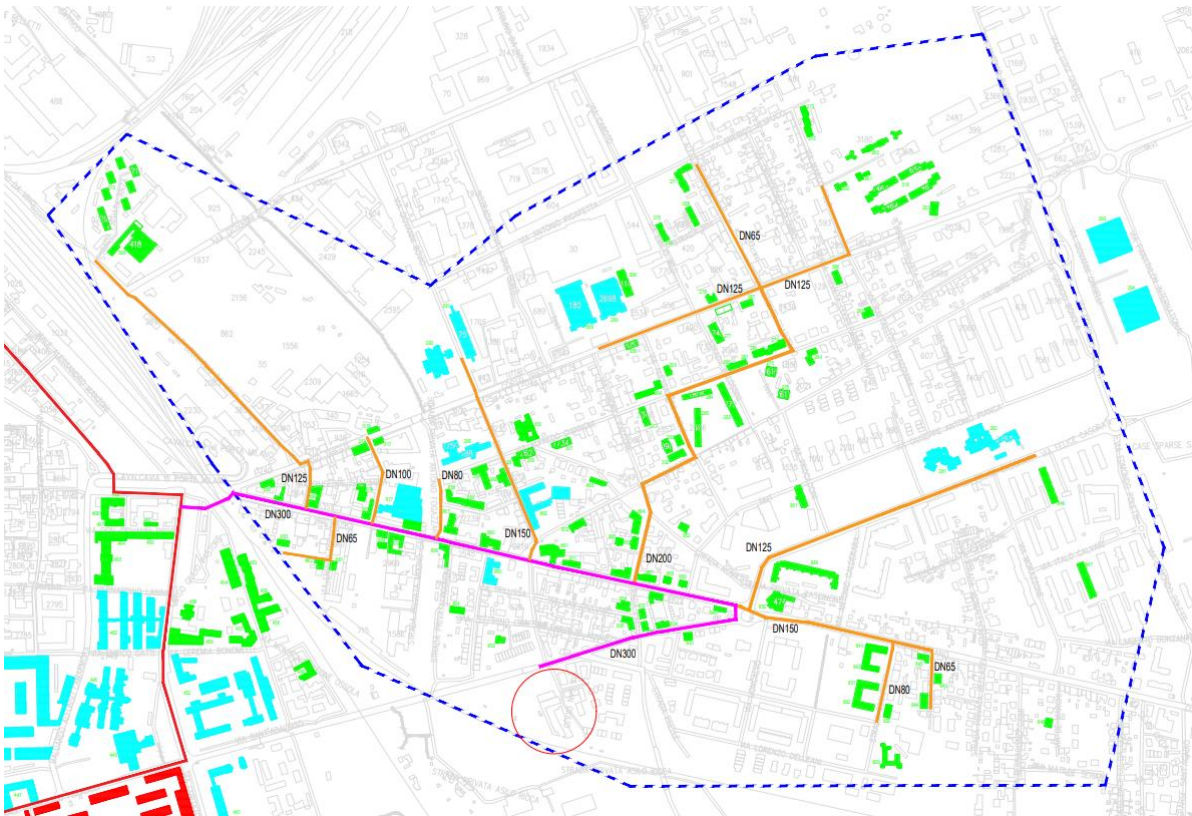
Planimetria e prima idea di sviluppo della rete di distribuzione del lotto 1
